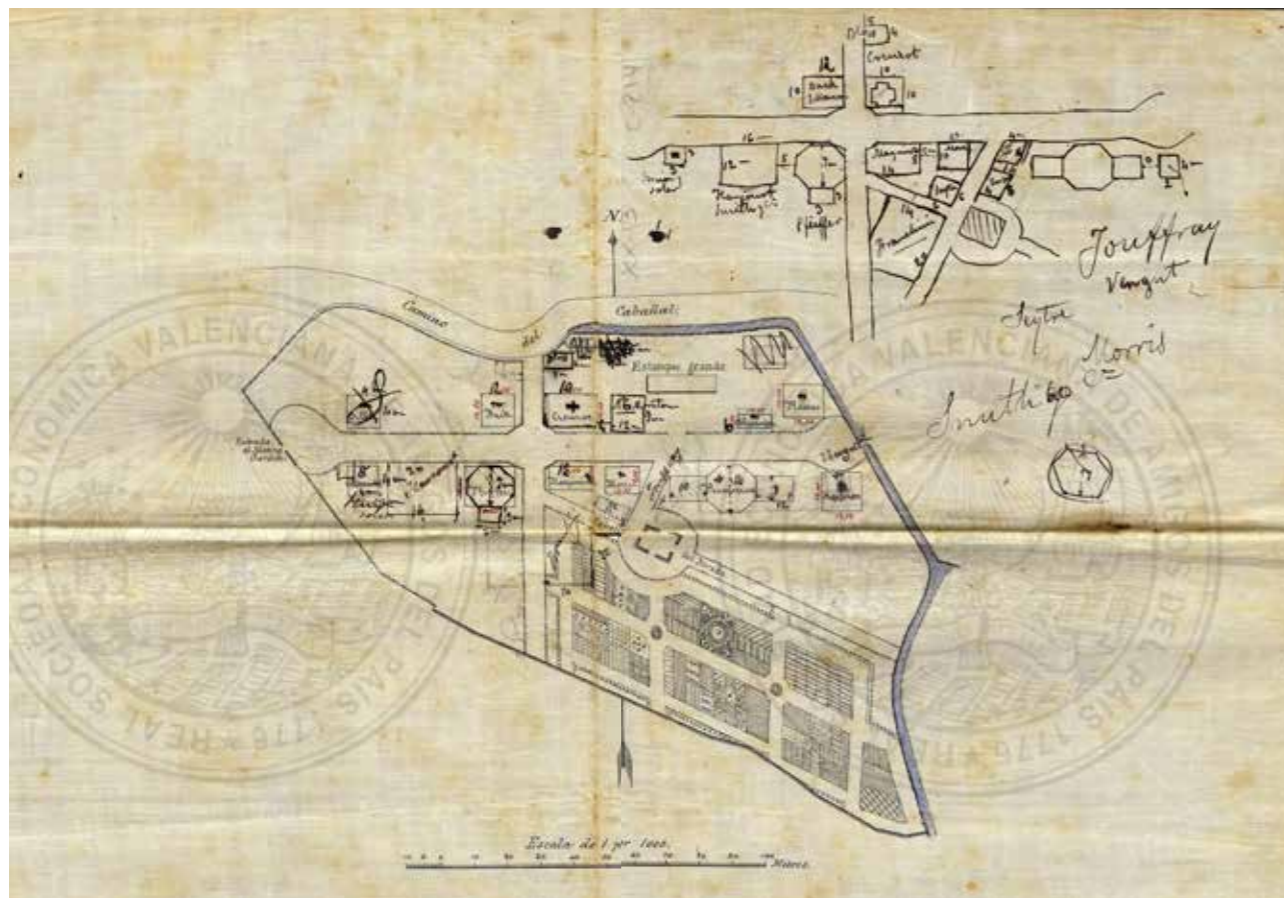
Boceto del plano de las Instalaciones, probablemente elaborado por José Camaña Laymon, arquitecto. Archivo de la RSEAPV.
